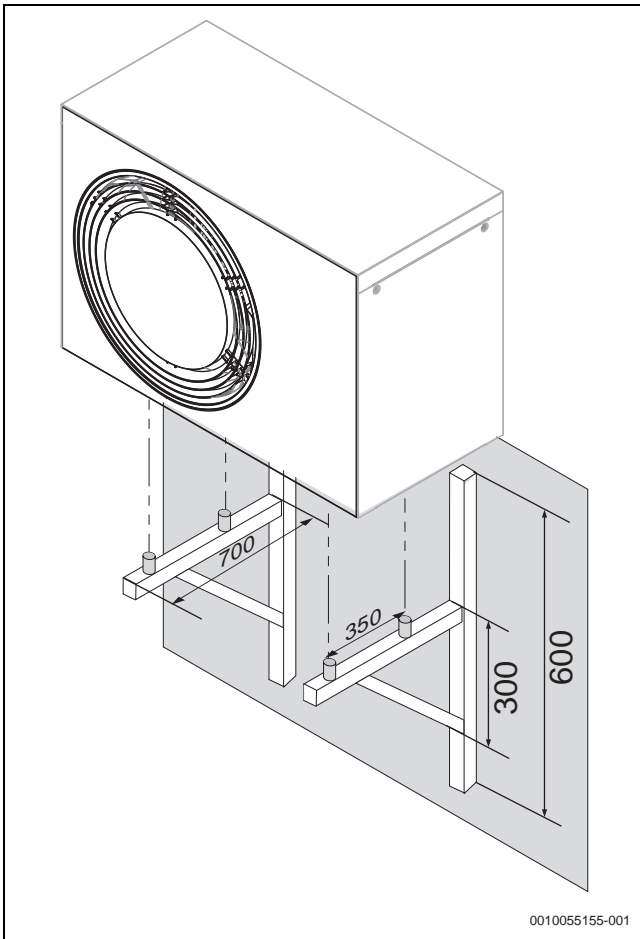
Abmessungen Wandkonsole (Maße in mm)
